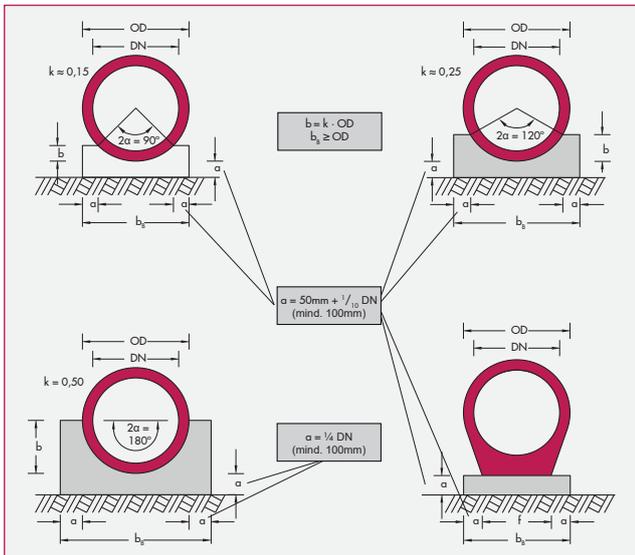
Bettung auf Beton (Beispiele für übliche Auflagerwinkel)
